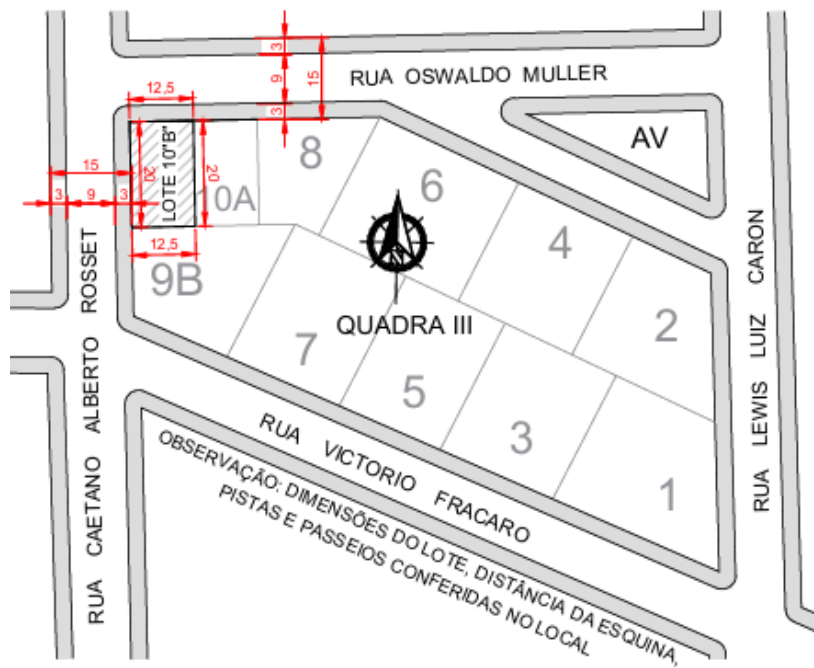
Planta de Situação do Imóvel conforme projeto aprovado pela Prefeitura Municipal
